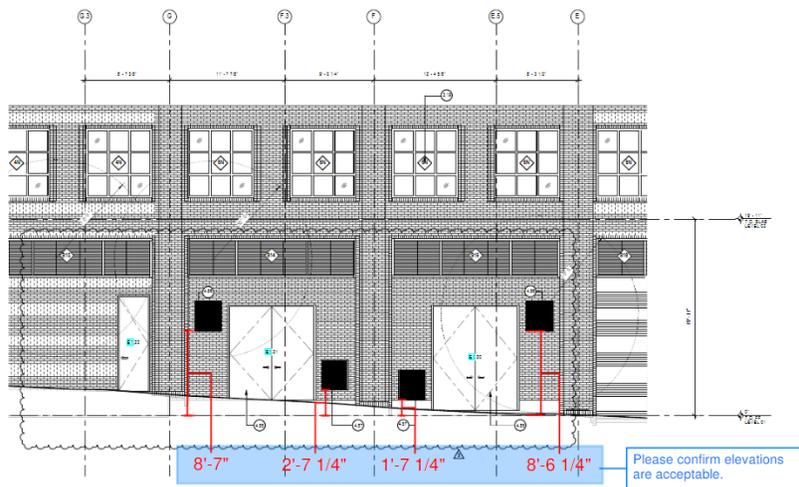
RFI 0489A: Transformer Room North-end Wall.
